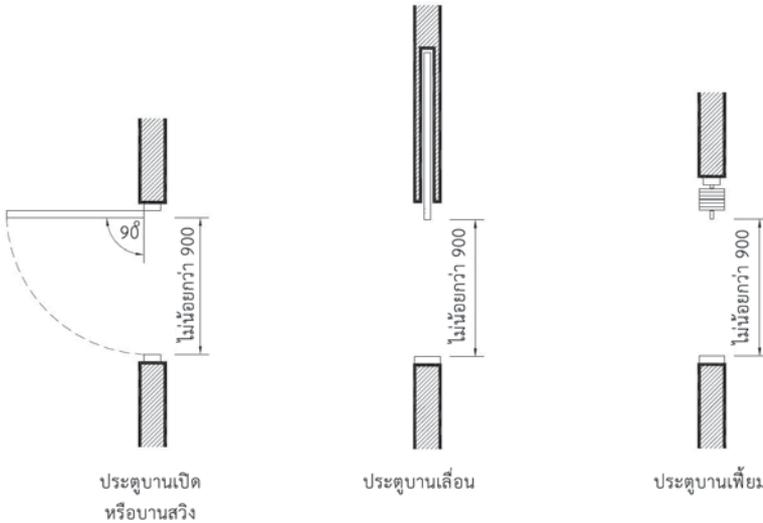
ทางสัญจรภายในอาคาร (asa หน้า 2-40)
